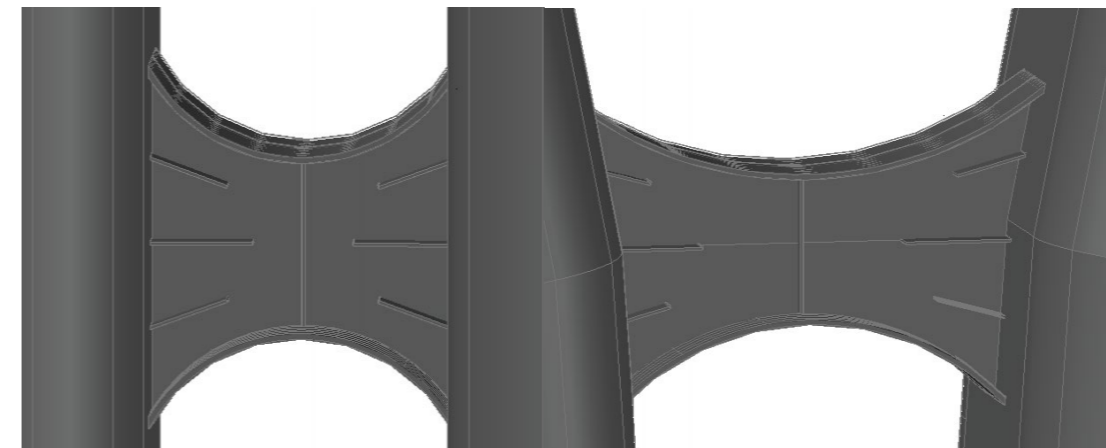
Vista 3D (en sombreado con aristas) de las vigas riostra de las torres (Izquierda: viga a $1/3$ de la altura, Derecha: viga a $2/3$ de la altura). Fuente: Elaboración Propia (AutoCAD)
